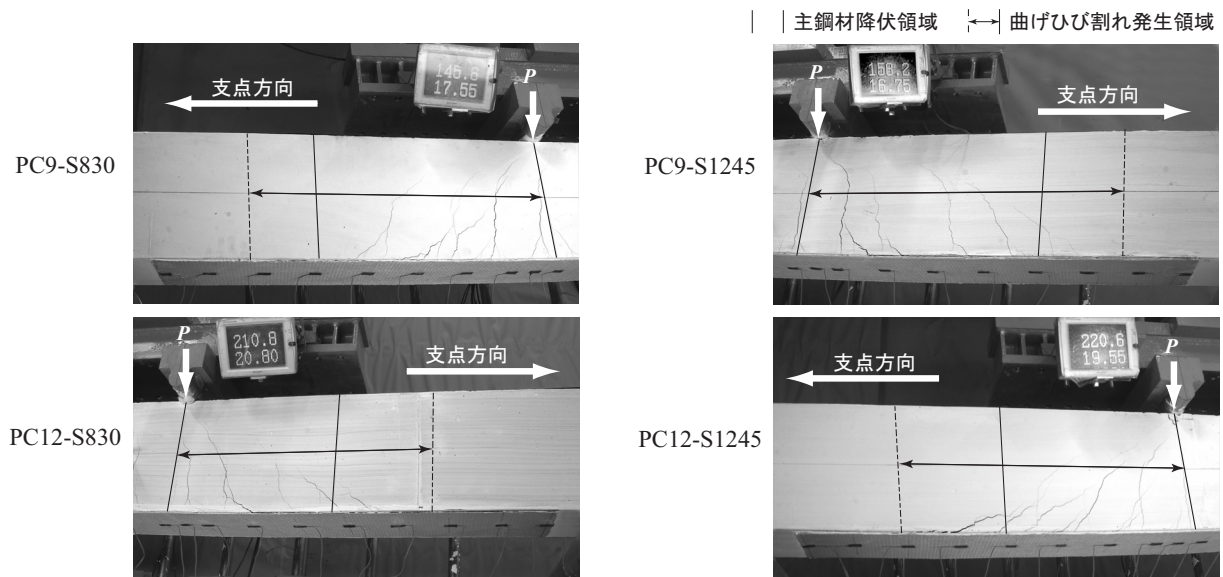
シート剥離直前のひび割れ性状（剥離破壊型）
